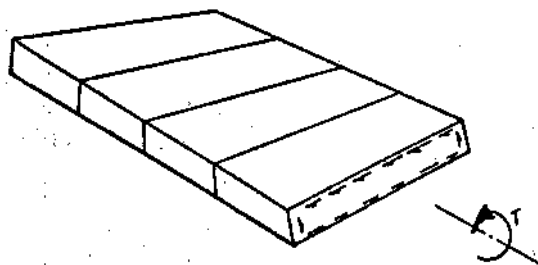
Torção em uma laje como se fosse viga, HAMBLY (1976)
